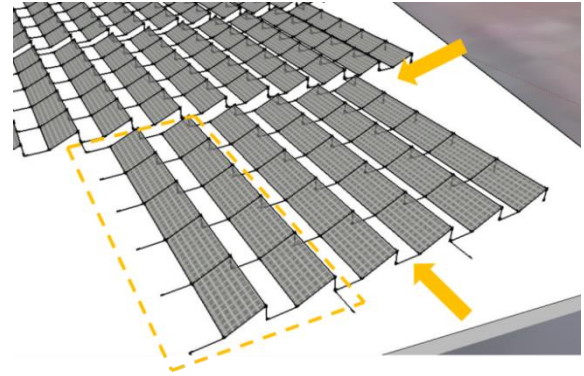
Vista do posicionamento e arranjo construtivo dos painéis
